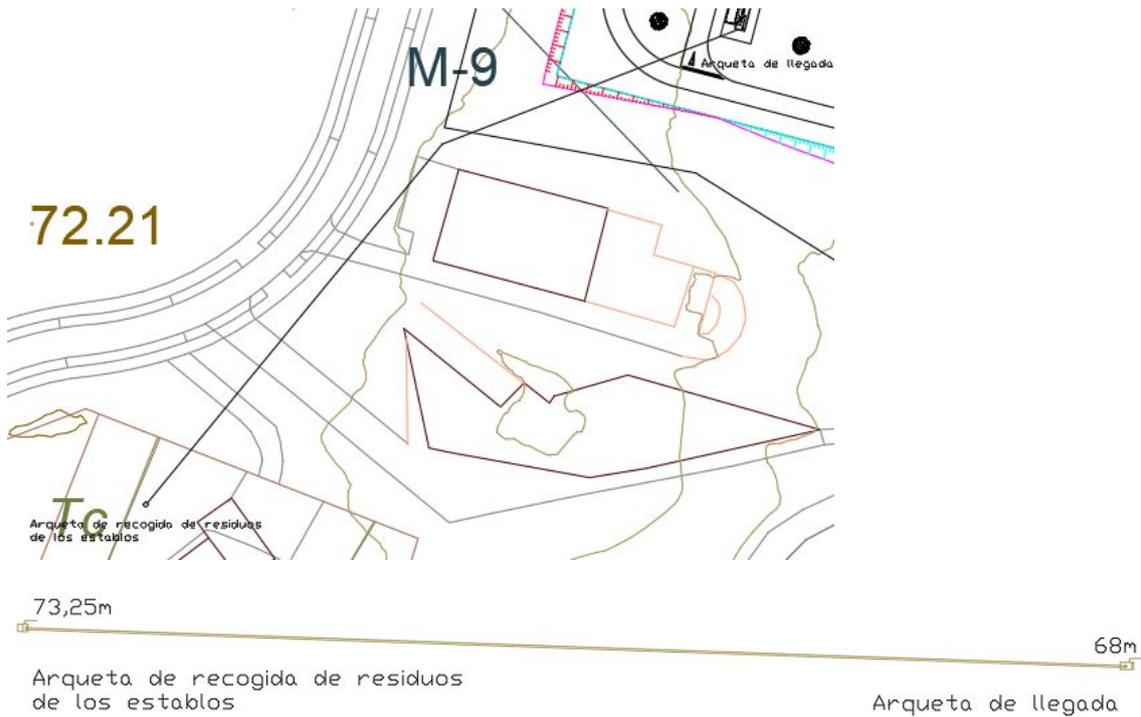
Plano detalle conexión granja y planta depuradora. Planta y alzado. Fuente: edición propia
